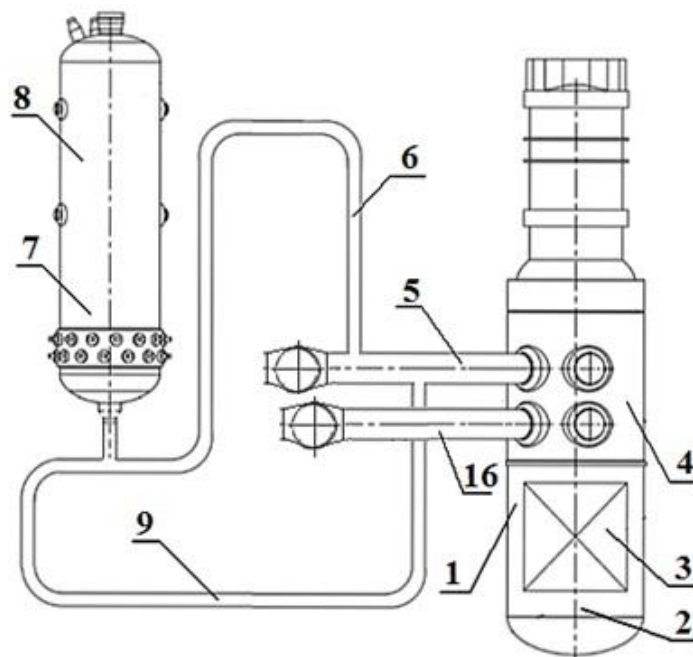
Акустический контур, образованный, КД и соединительными трубопроводами [Acoustic circuit, formed by PC and connecting pipelines]
